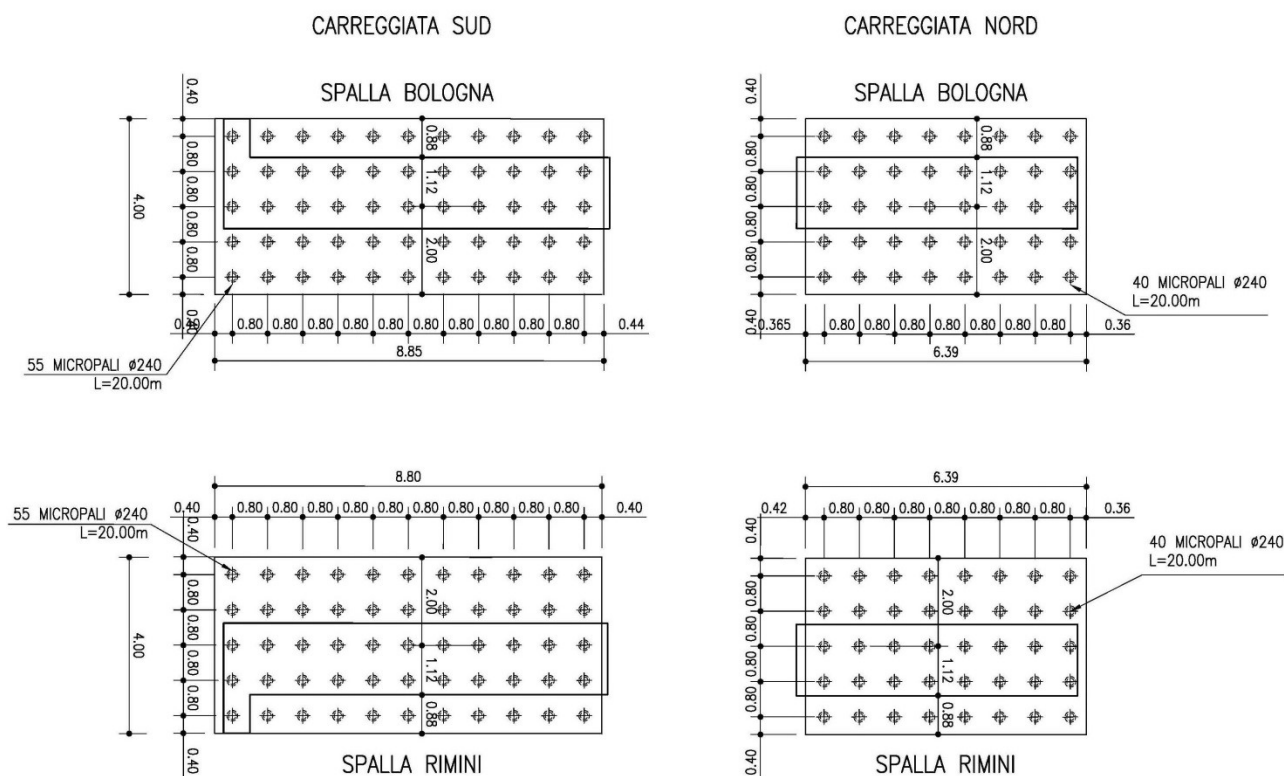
Spalla – Pianta Fondazioni
